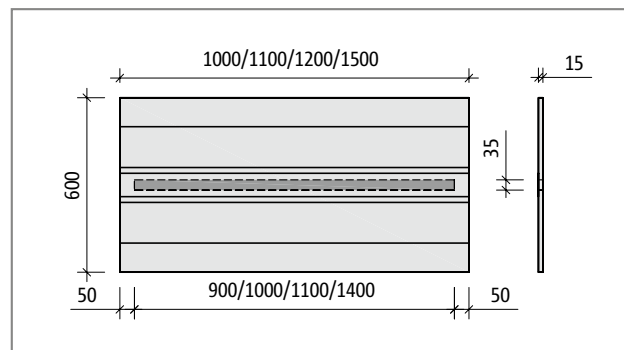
Schöck Tronsole® Typ B-V2-L...-B600: Produktgrundriss
